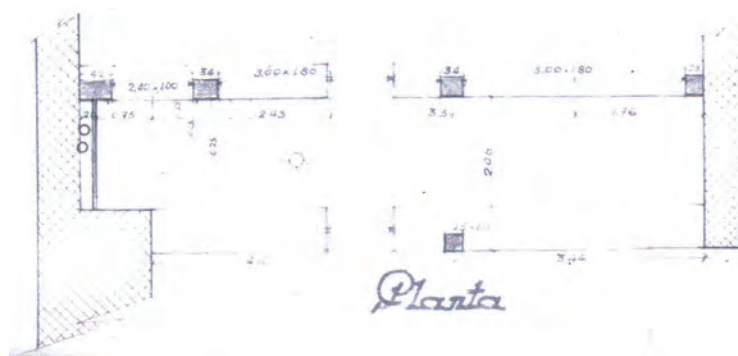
16. 1955 PLANTA BAJA DEL ESTADO PROPUESTO
